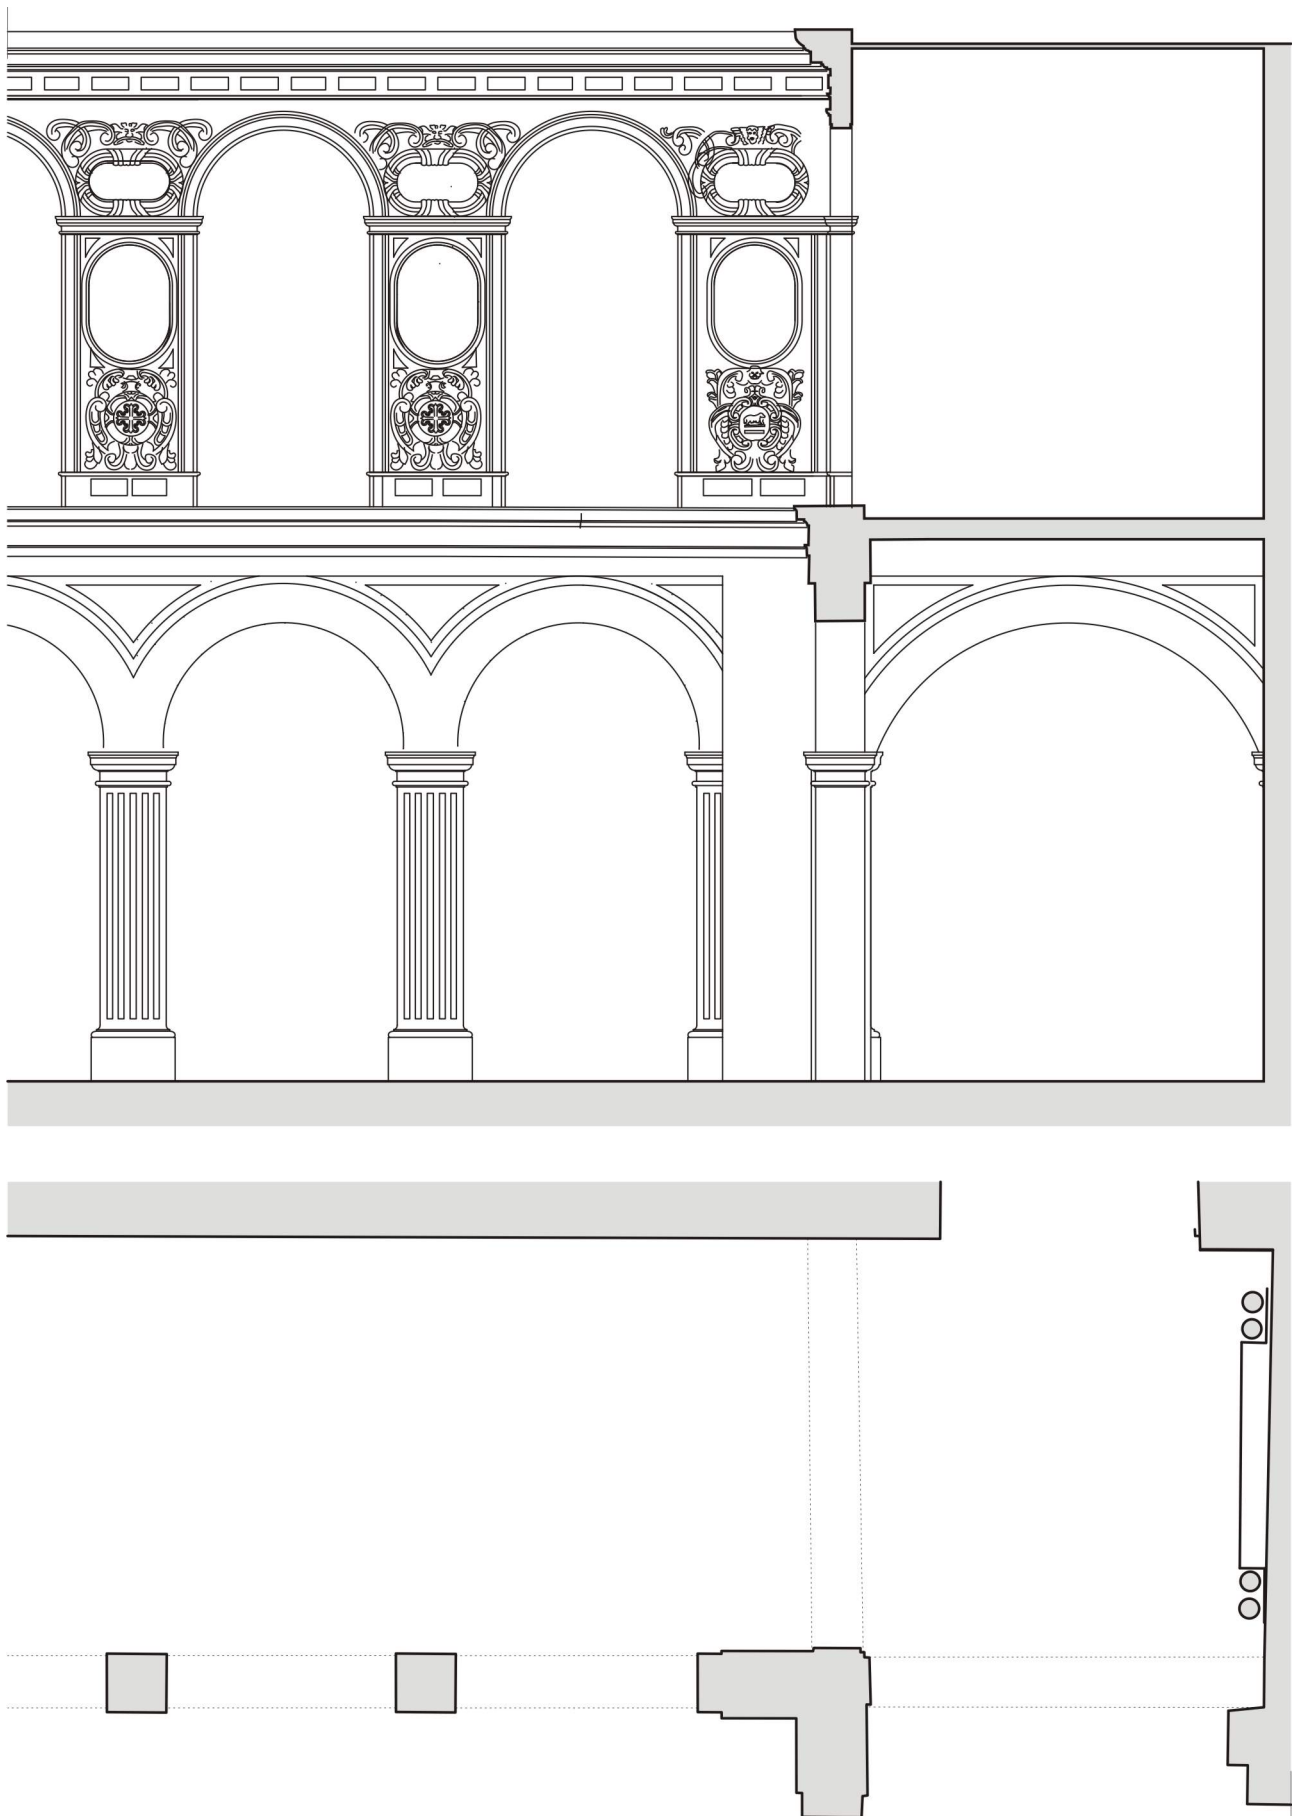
Santo Domingo, Claustro Mayor. Bestand. Erdgeschoss händisch im Referenzlinienverfahren aufgenommen. Obergeschoss nach Fotografie.
